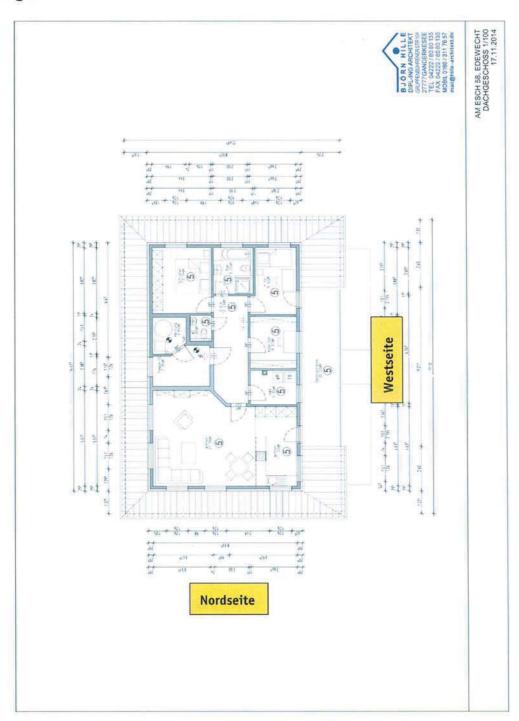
Das Gestaltungskonzept bzw. der Grundriss für das Dachgeschoss im 5-Parteien-Wohnhaus auf dem Plangebiet.
